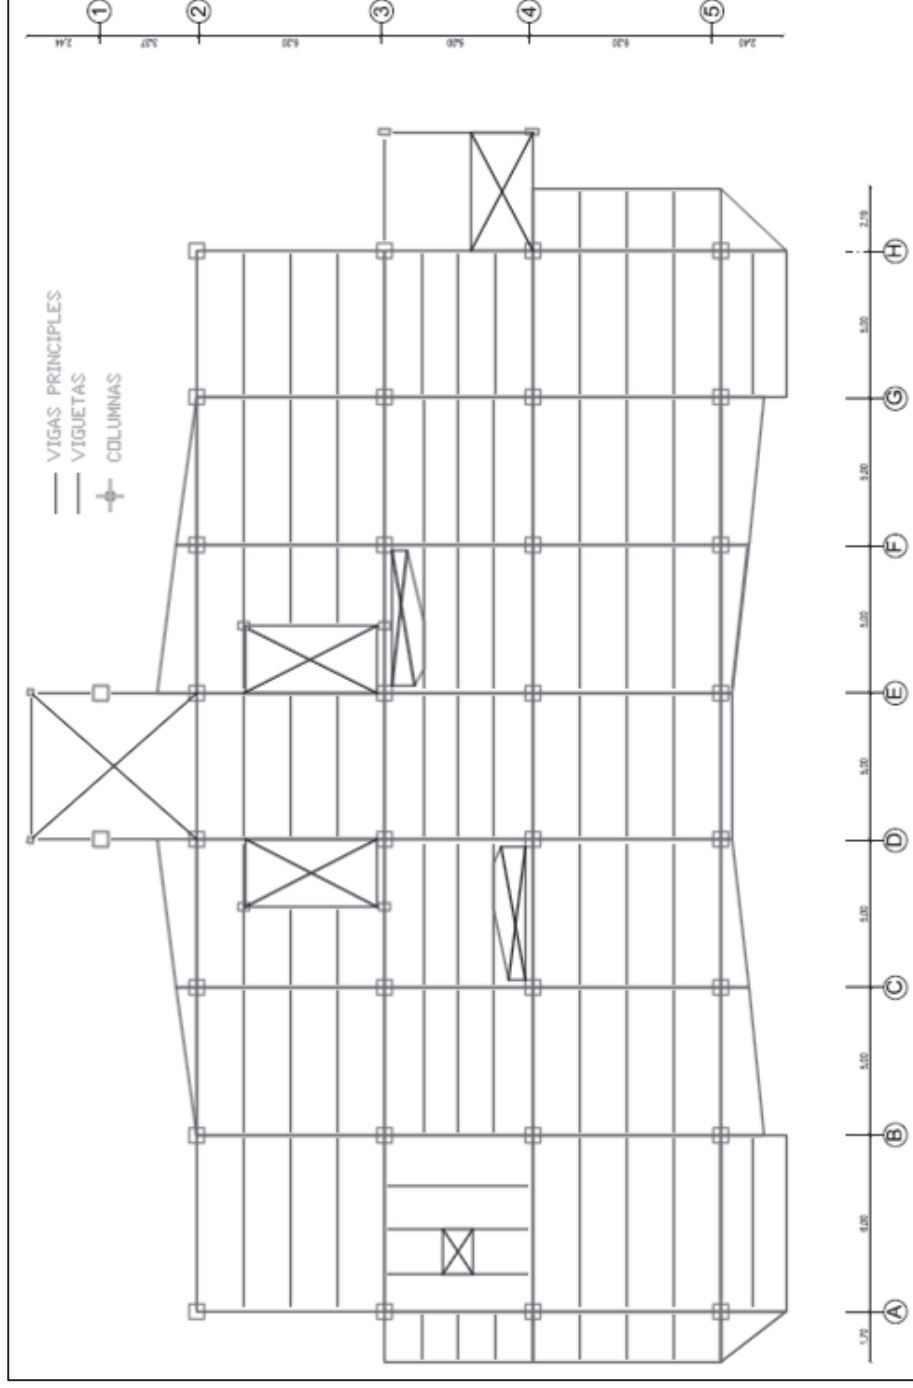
PLANTA ARQUITECTÓNICA EDIFICIO UNACH
